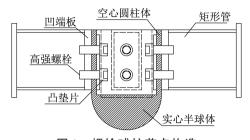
螺栓球柱节点构造 Fig. 1 Details of bolted ball-cylinder joint
